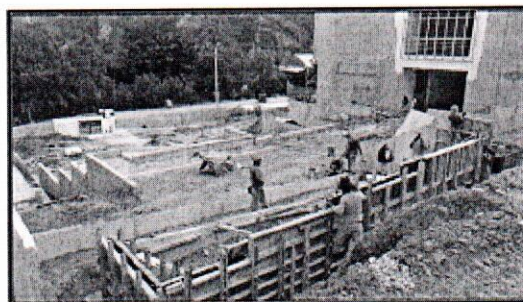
VERIFICACIÓN DE ENCOPRADO DE MURO DE CONTENCIÓN PARA RAMPA DEL INGRESO SECUNDARIO N° 02
